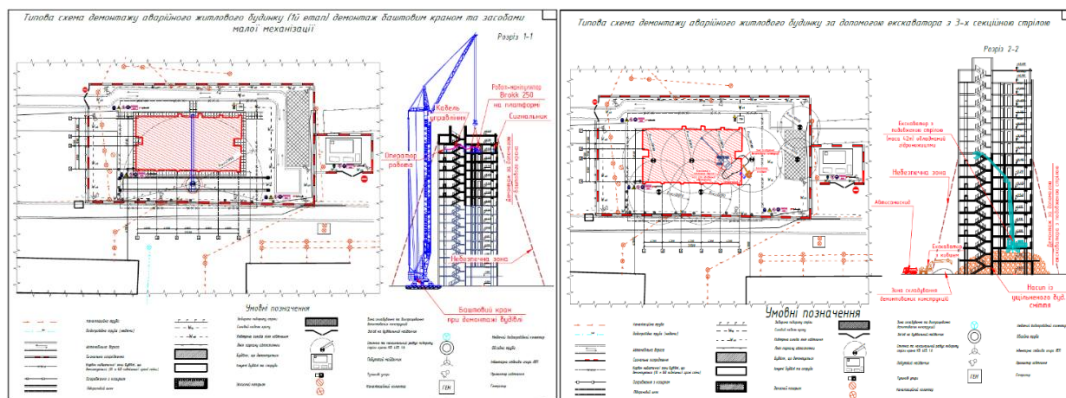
Технологічна схема демонтажу 14-ти поверхового будинку (етап 1 – демонтаж баштовим краном, етап 2 – демонтаж екскаватором з подовженою стрілою)
